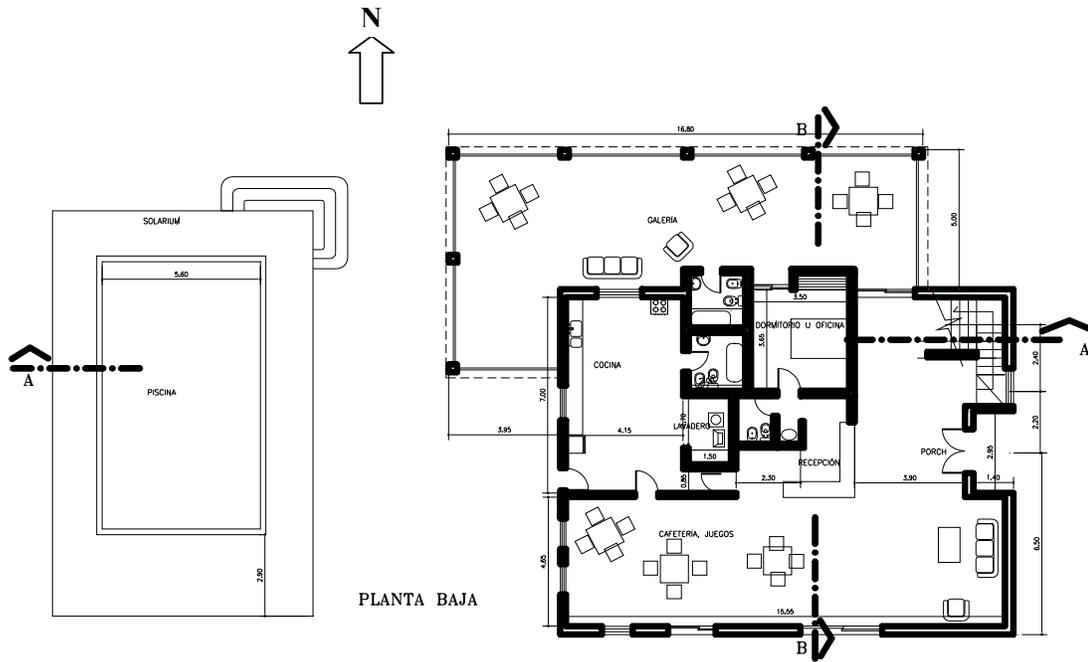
Planta baja remodelada y piscina a calefaccionar existente
